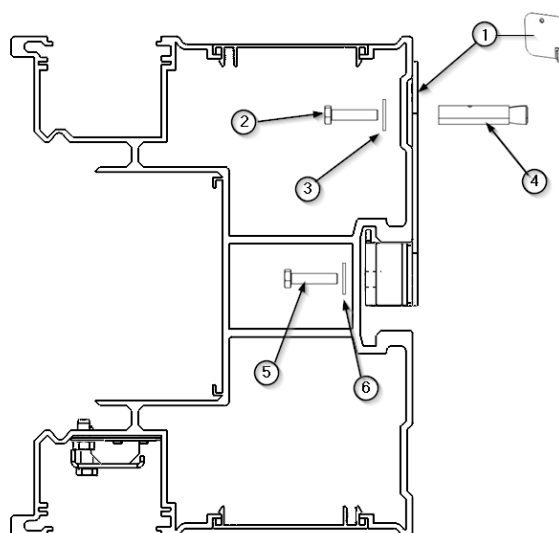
Fixation de l'équipement à un mur de maçonnerie conventionnel
